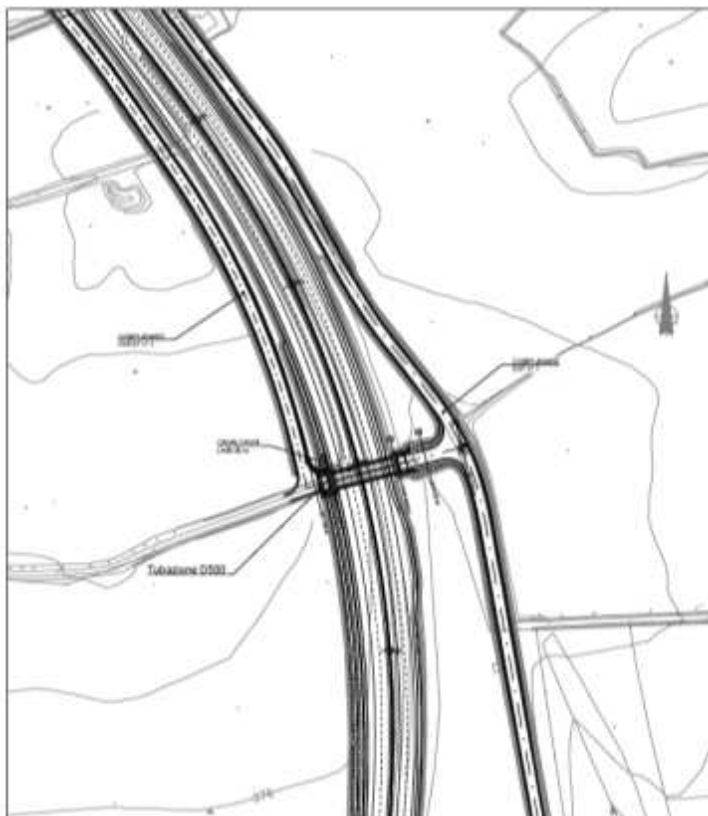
Planimetria Casvalcavia al Km 1+800
